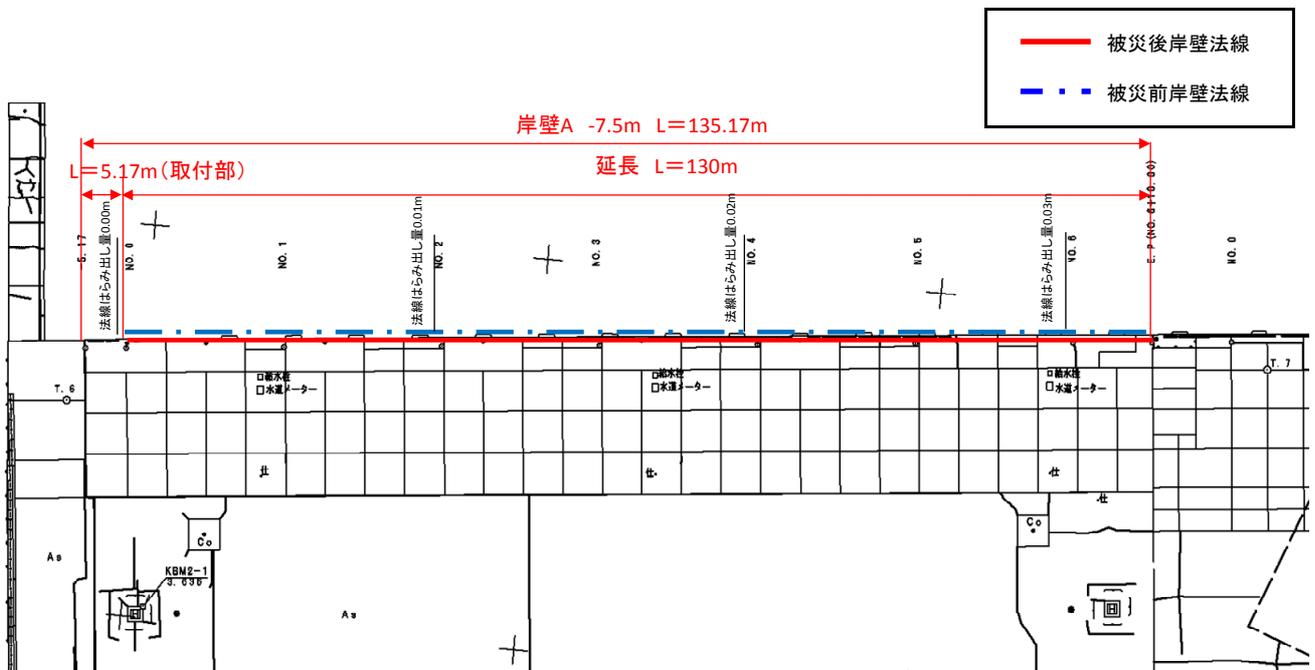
No.20 常陸那珂港区_中央ふ頭地区岸壁 (-7.5m) の平面図 (被災後)
